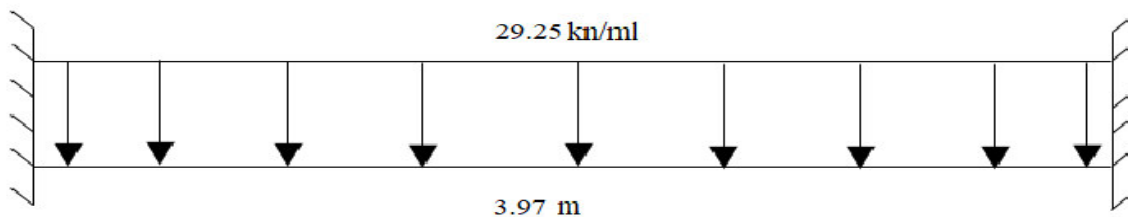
Schéma Statique de la poutre palier (escalier type 02)
